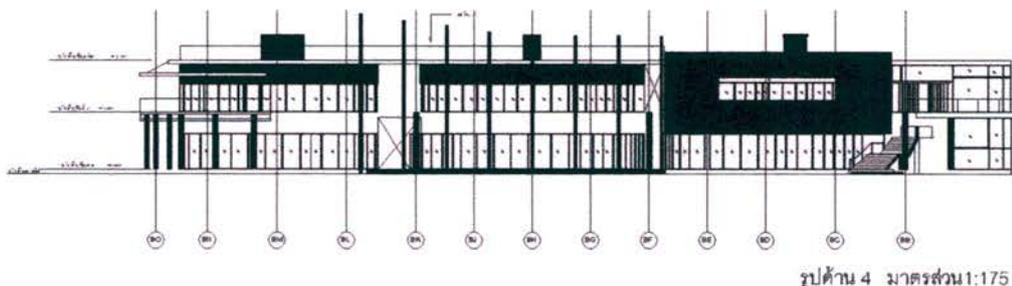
แสดงภาพ ELEVATION B
